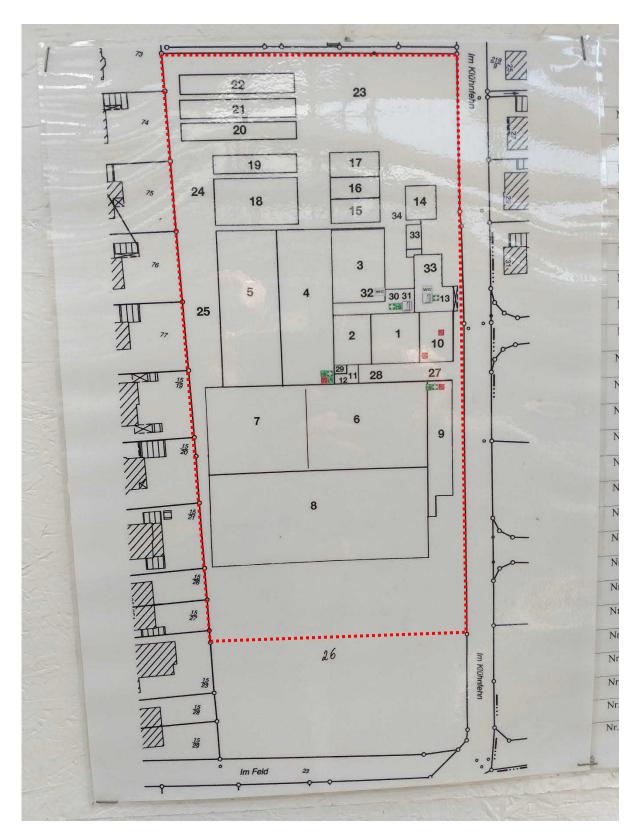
Betriebsfläche der Gärtnerei mit baulichen Anlagen; Bewertungsfläche gekennzeichnet
